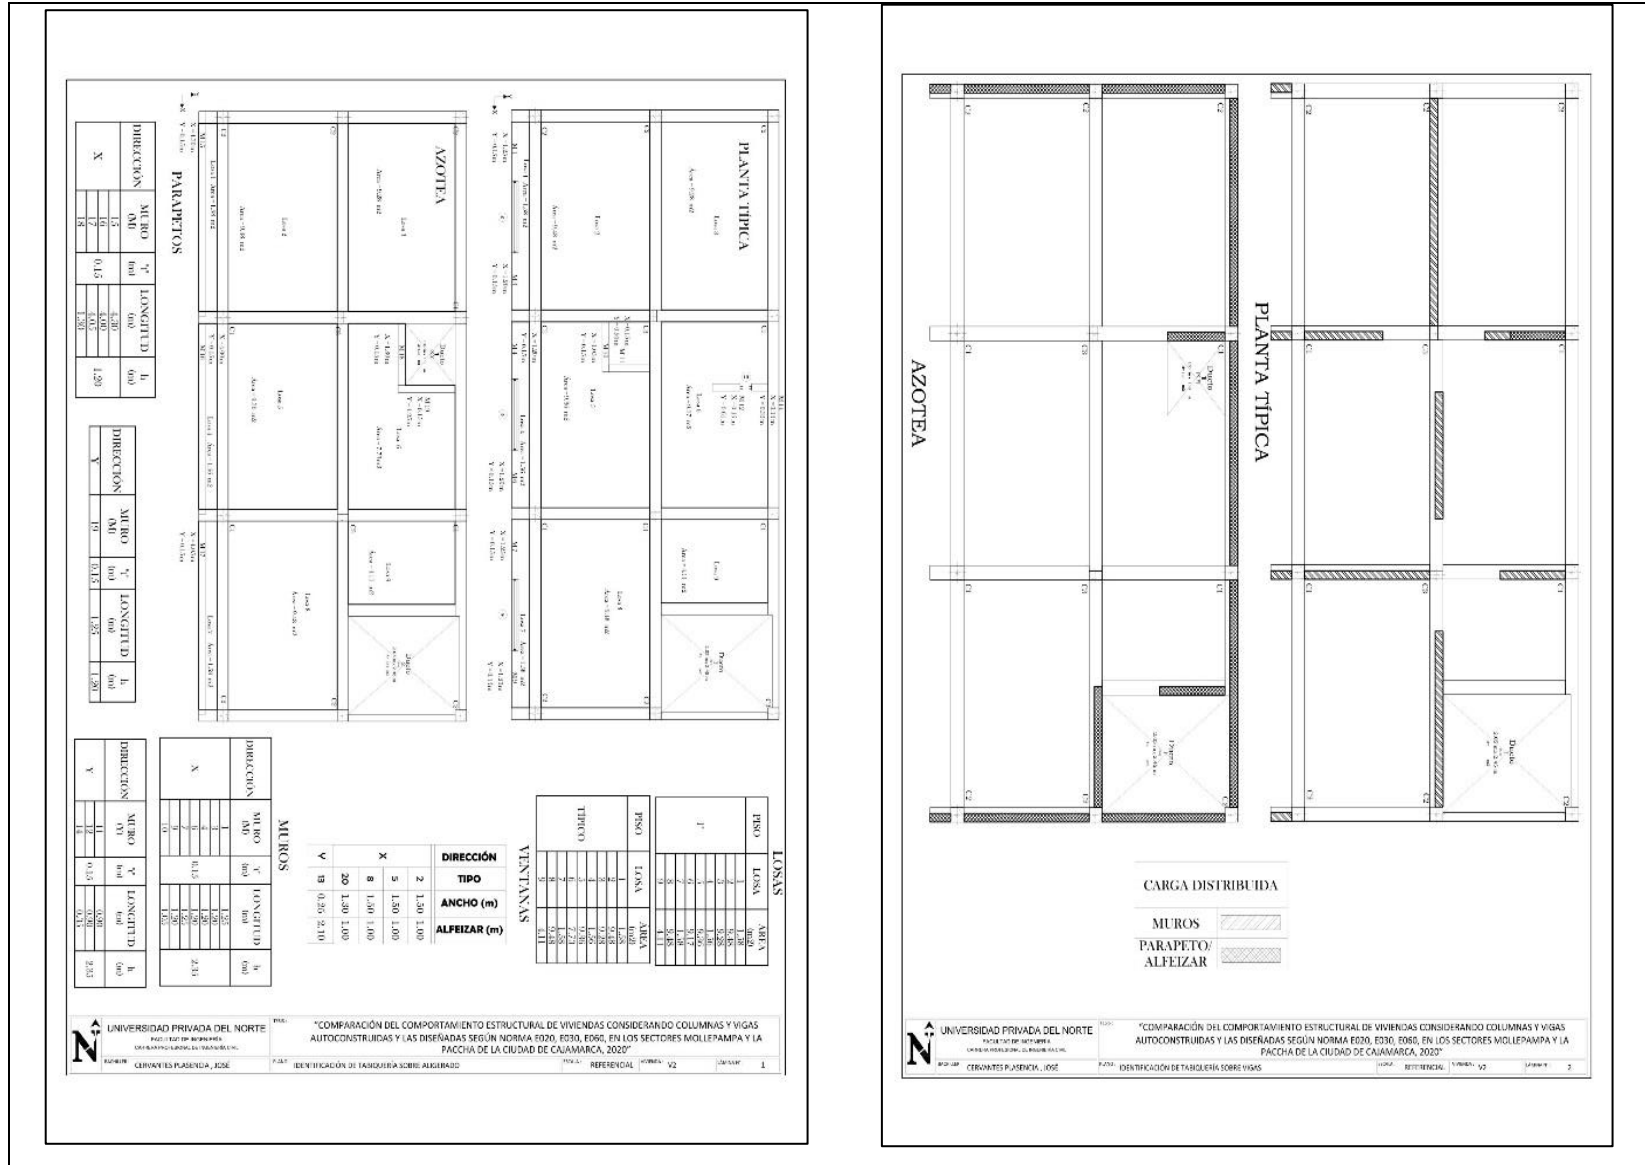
Tabiquería sobre losa aligerada y vigas vivienda 3
